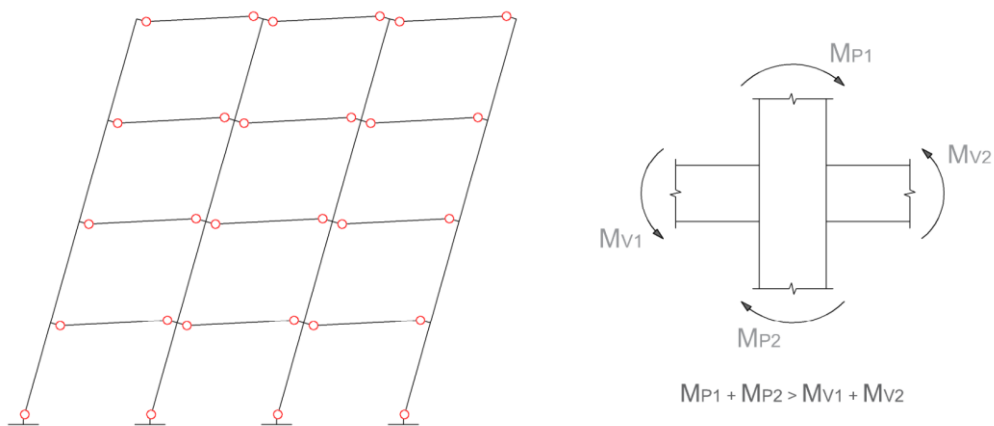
Patrón de colapso lateral viga débil – columna fuerte
